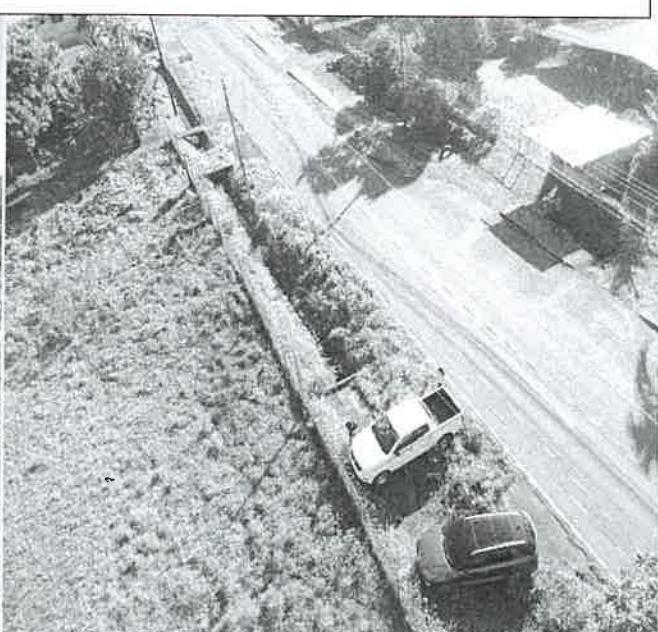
Vista del lote y la vía Paso Canoas a Puerto Armuelles
